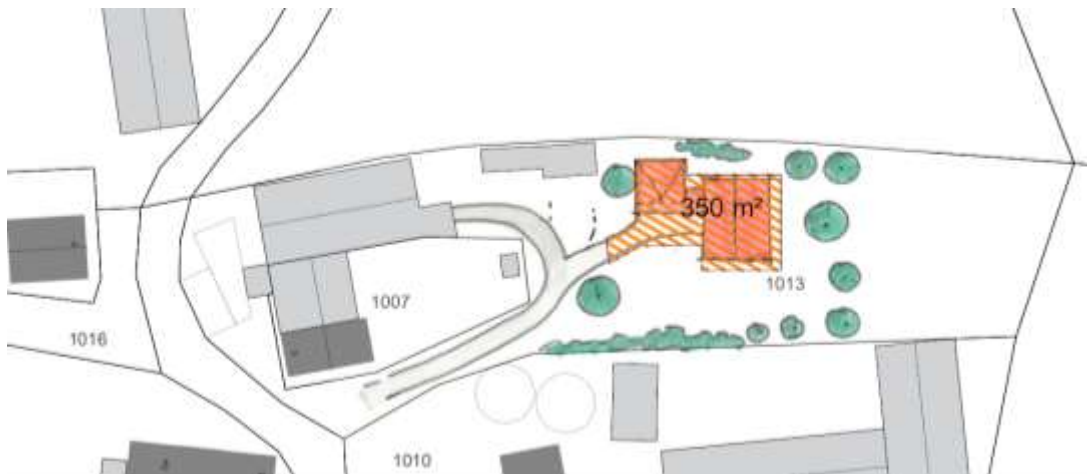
Geplante bauliche Ergänzung mit Eingriffsbereich
